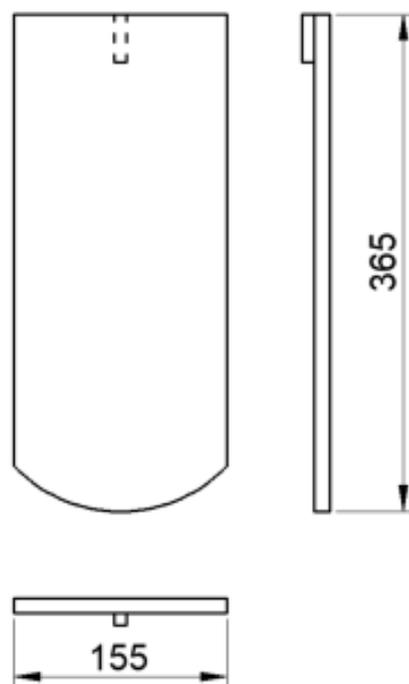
Габаритные размеры и форма цементно-песчаной плоской ленточной черепицы
